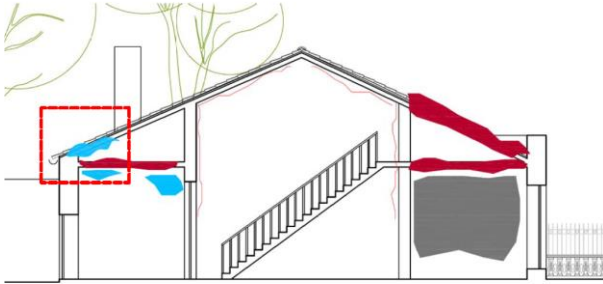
Encuentros con chimeneas y paño general de cubierta. 2023. Fuente: propia.
